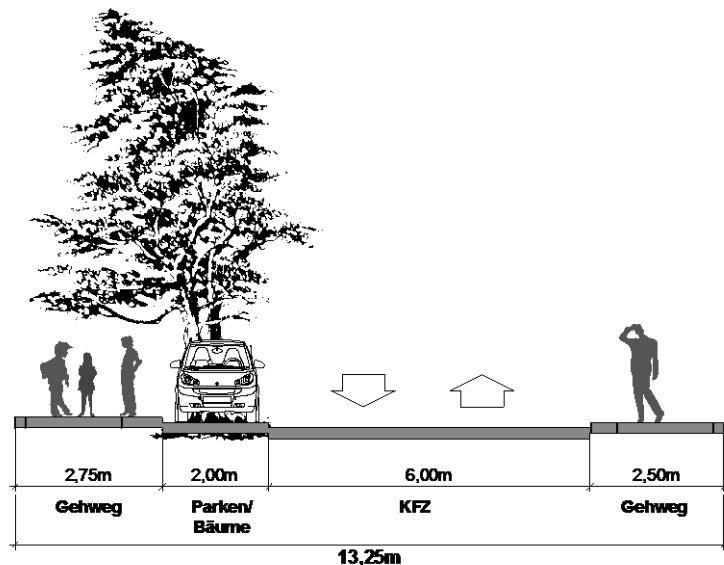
Straßenquerschnitt Planstraßen A und E
